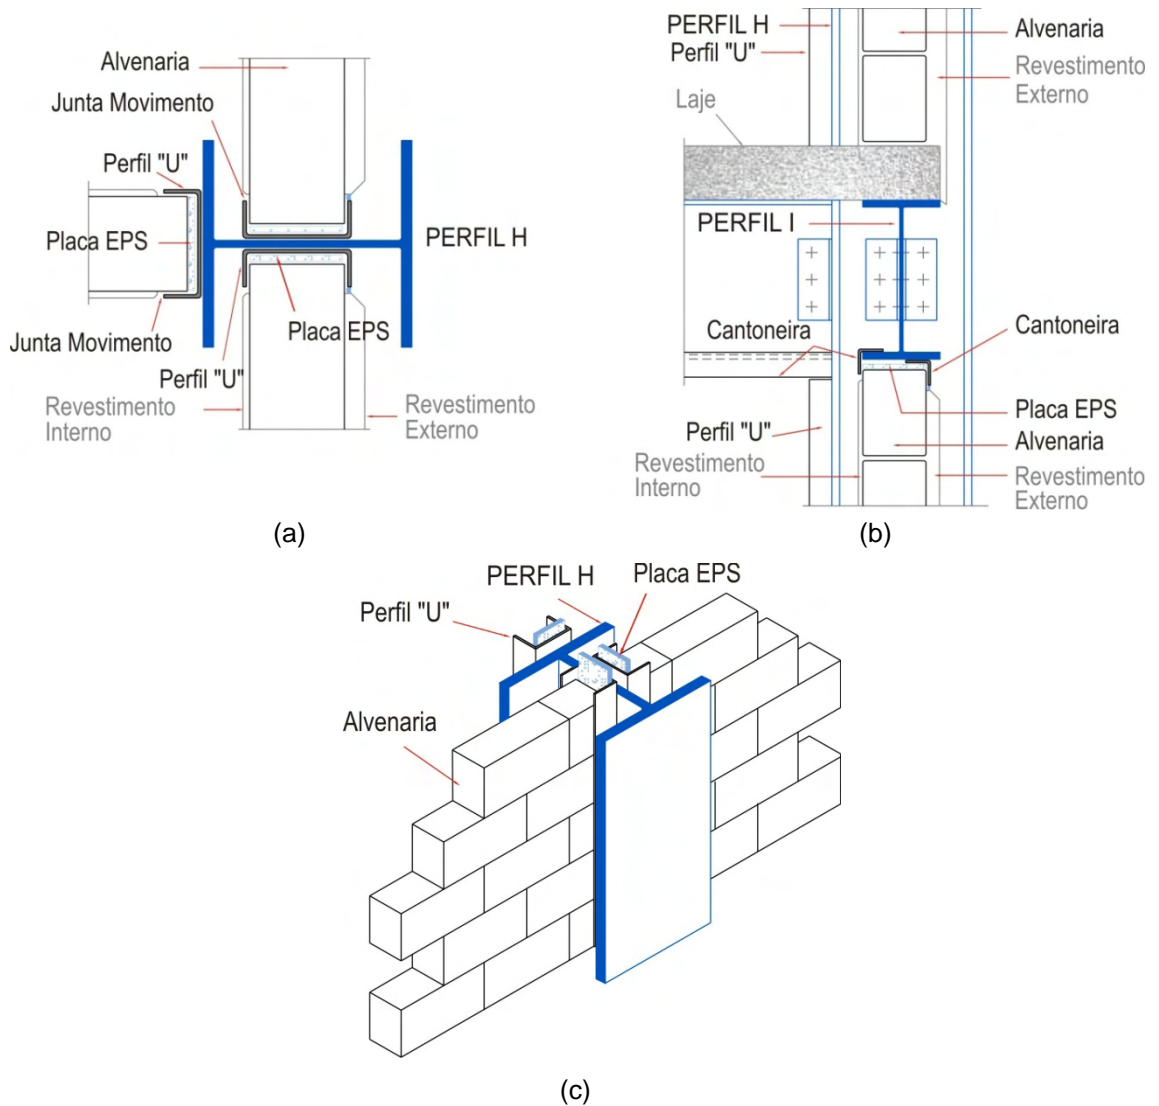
Esquema de fechamento em alvenaria no mesmo plano da estrutura. (a) Planta; (b) elevação; (c) perspectiva (Adaptado de COELHO, 2004).
